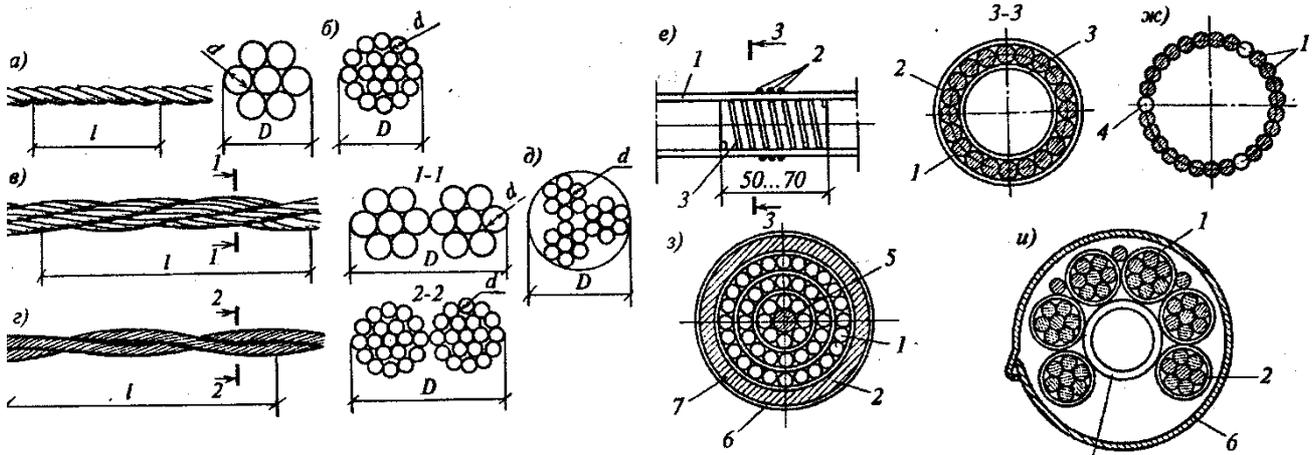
Арматура для предварительно напряженных конструкций:
